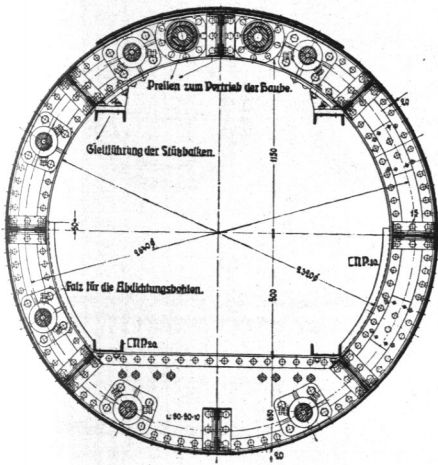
Tunnelstrecke der Bürgerweide, Brustschild, Querschnitt.
